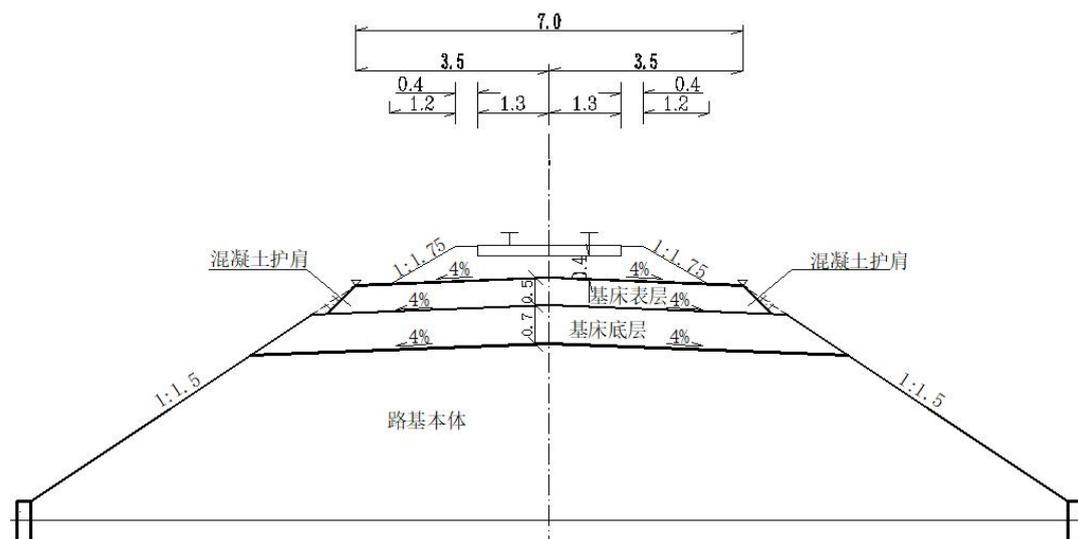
新建单线有砟轨道路堤标准断面图 (1:100)
